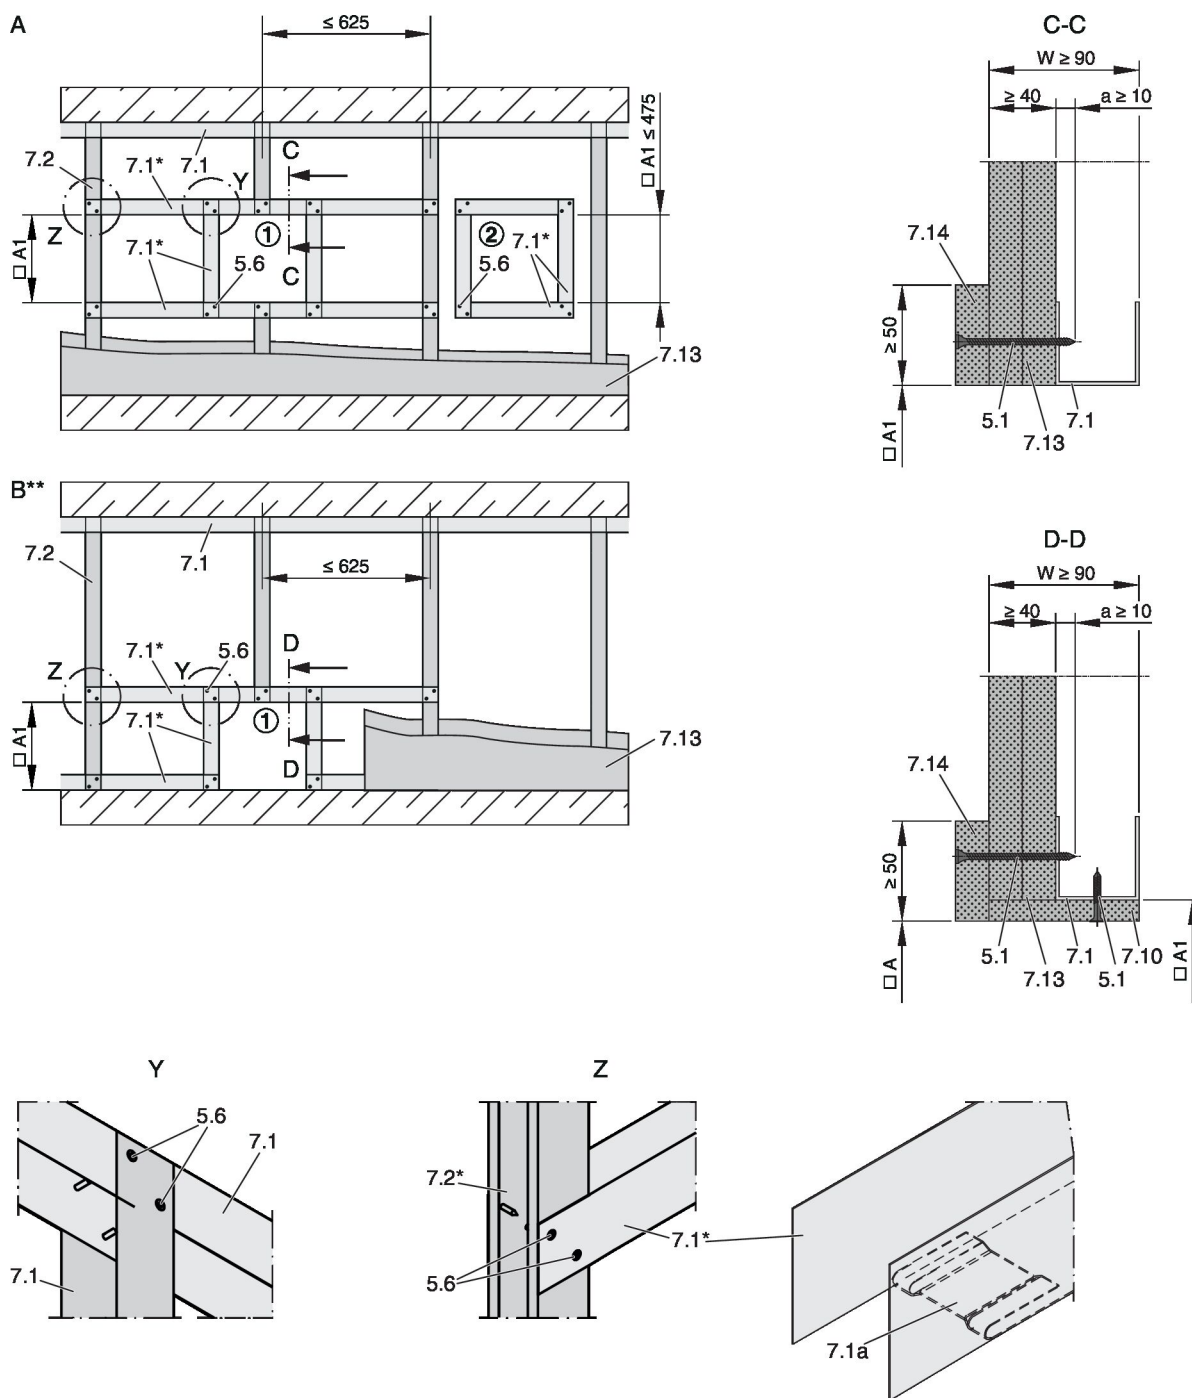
Стени на шахти с метална поддържаща конструкция – подреждане/разстояния
